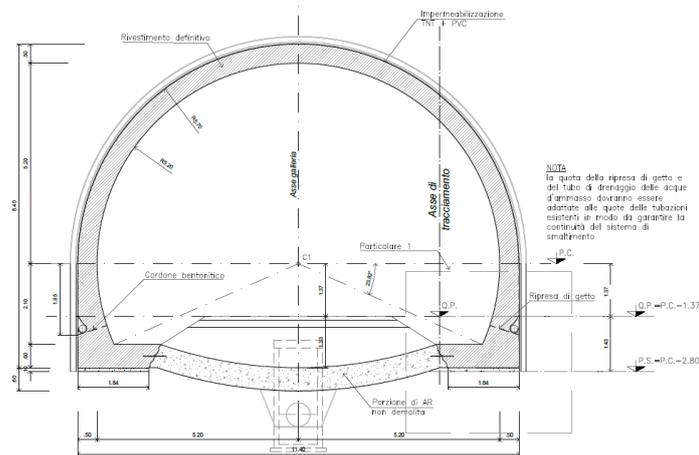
Galleria Guinza – Intervento Tipo A – Sezione corrente – Carpenteria
